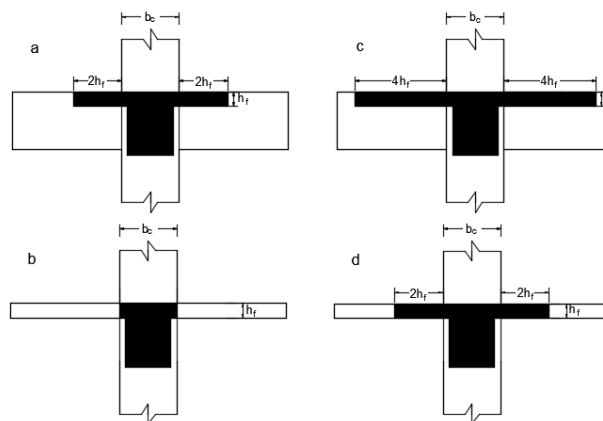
largura efetiva b_{eff} para vigas ligadas a pilares
